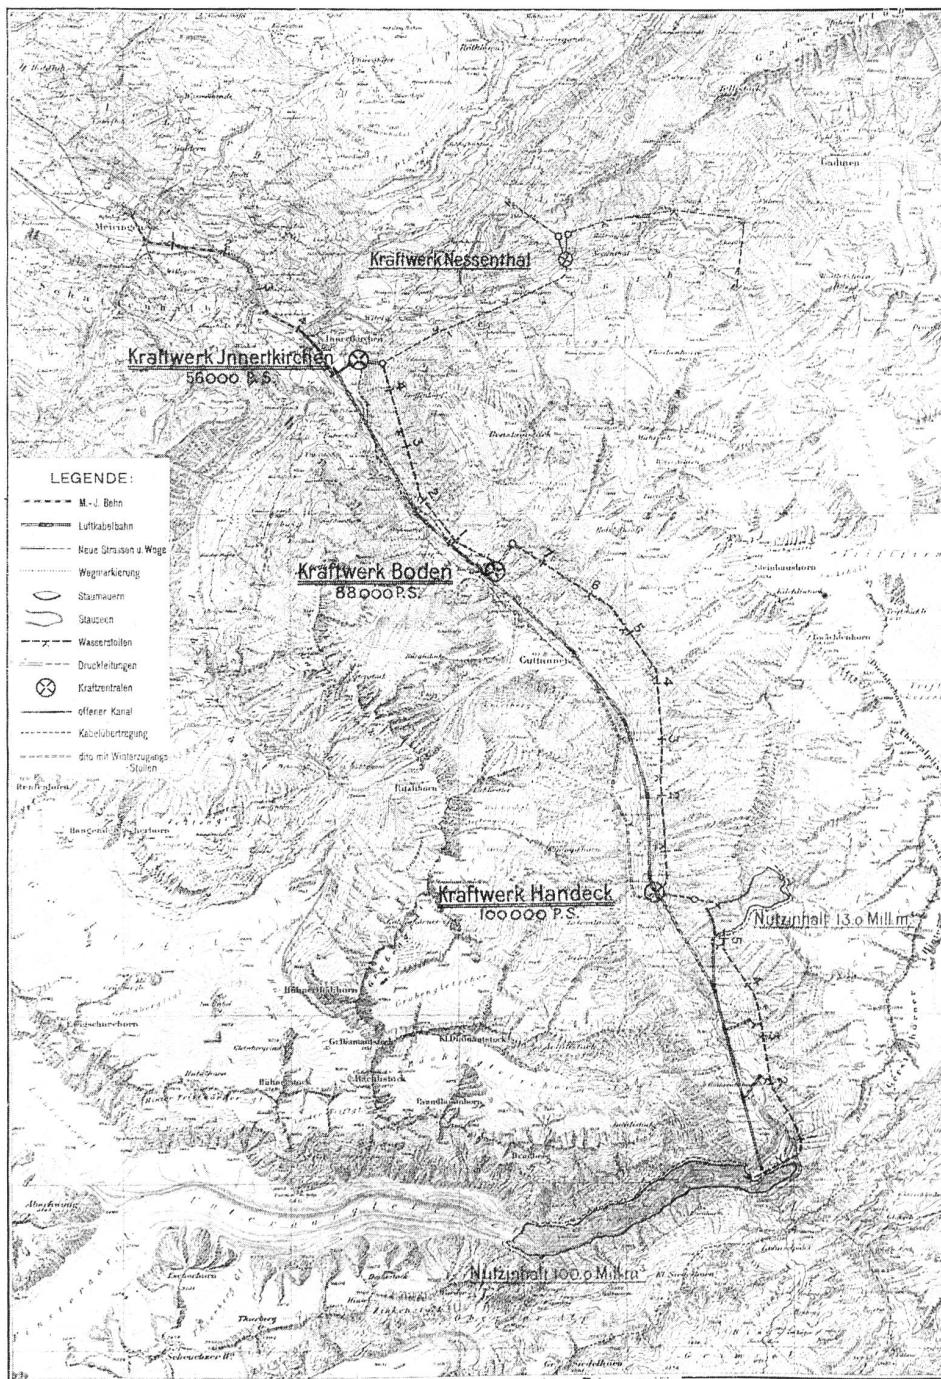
Oberhasli (im Bau). Übersichtsplan der projektierten Anlage. Maßstab 1 : 130 000.
